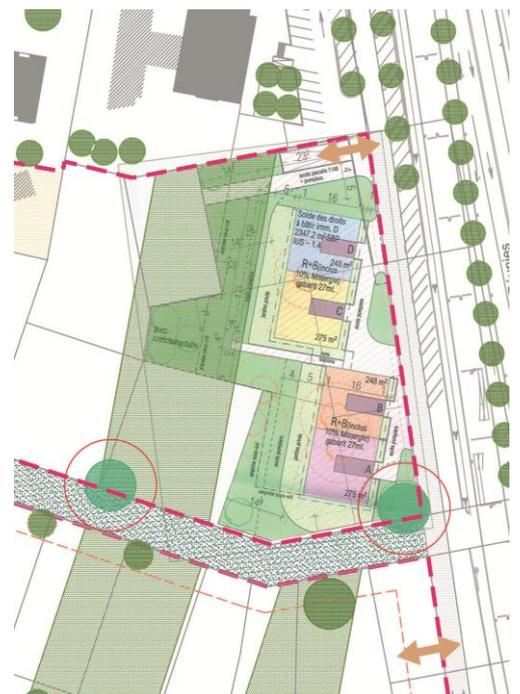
Plan du projet de KM&S pour la Fondation FPLC superposé au PDQ
